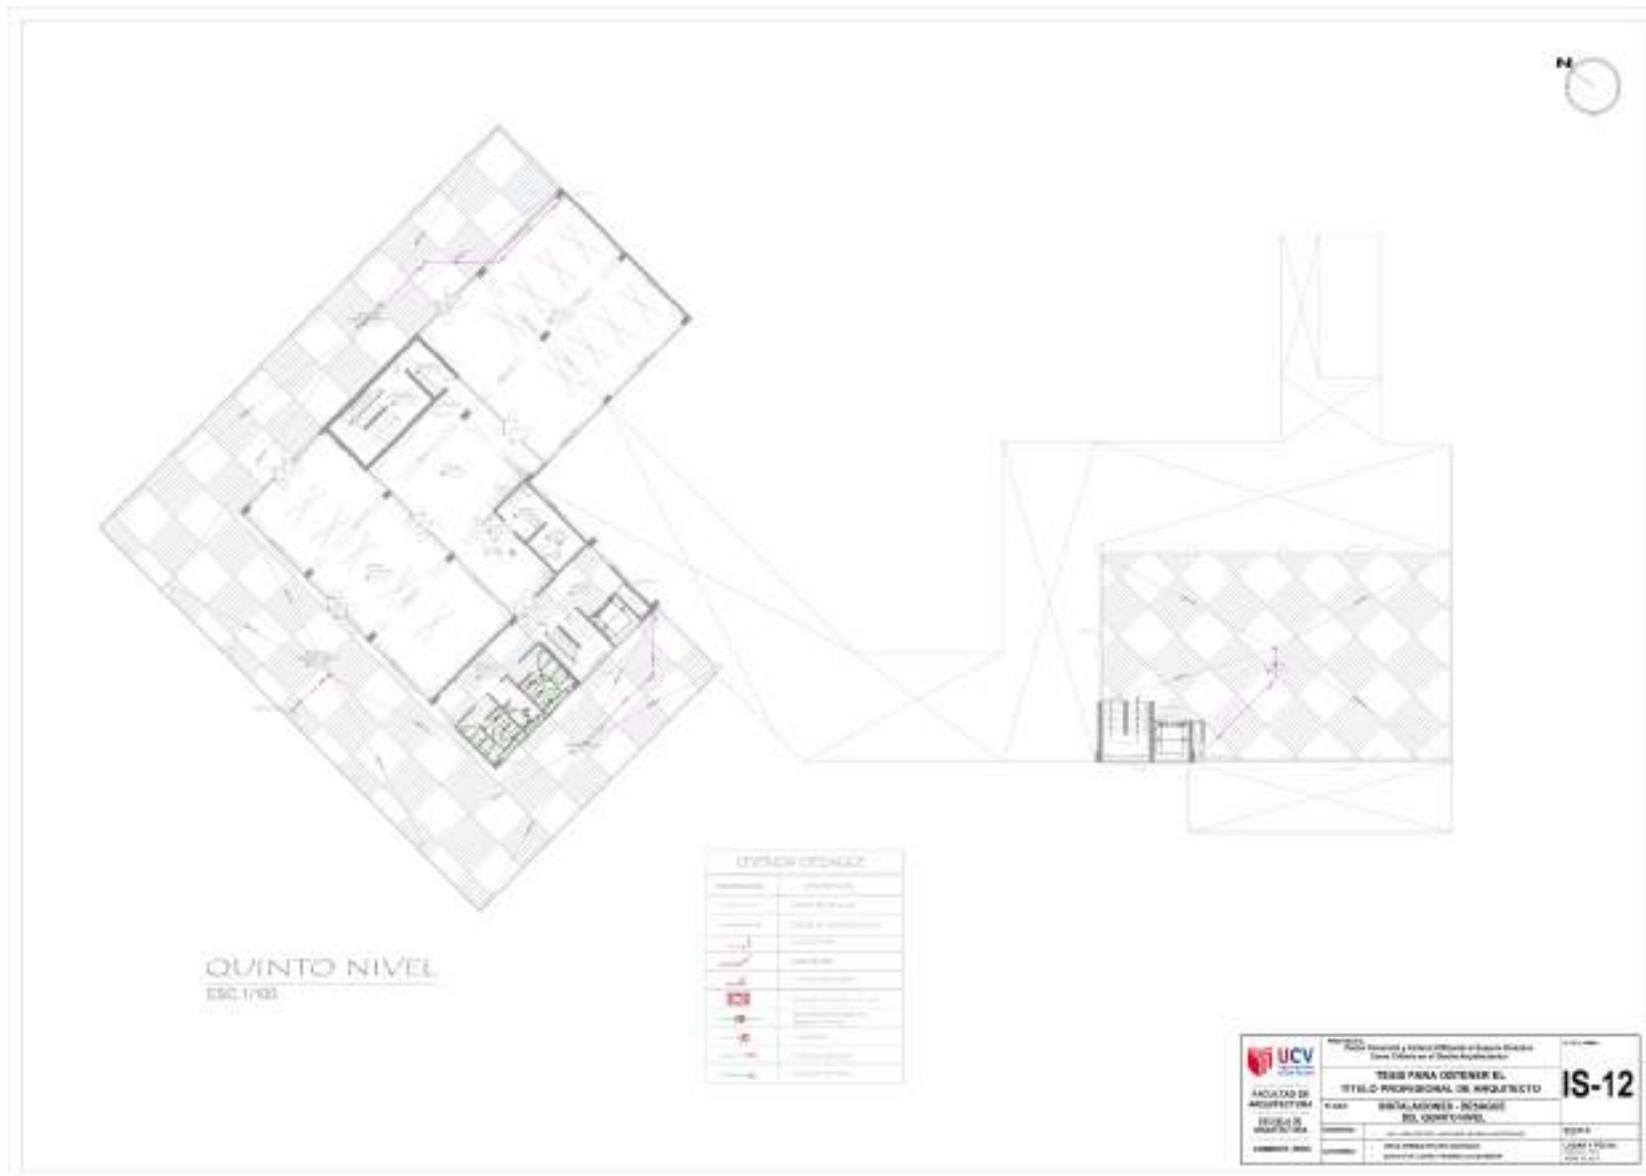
Plano de instalación de desagüe y pluvial quinto piso
